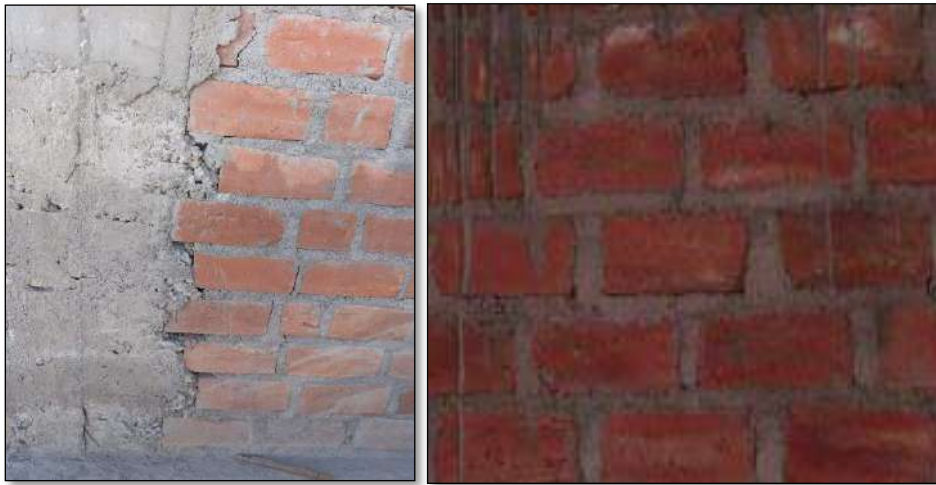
Verticalidad de los muros y albañilería solida artesanal.
